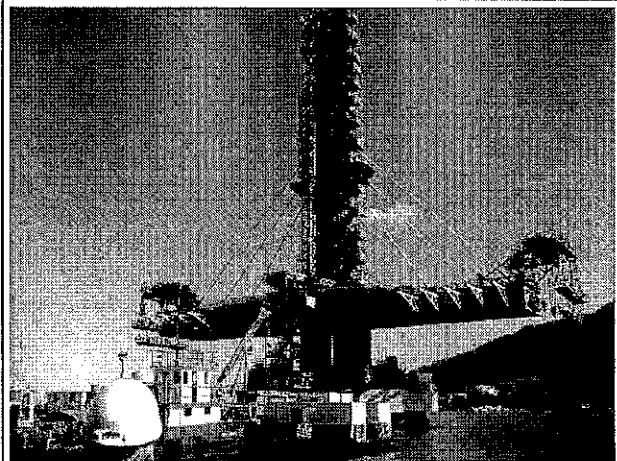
Presença de embarcações na área de apoio instalada na base da torre de ancoragem dos cabos de sustentação da superestrutura.
